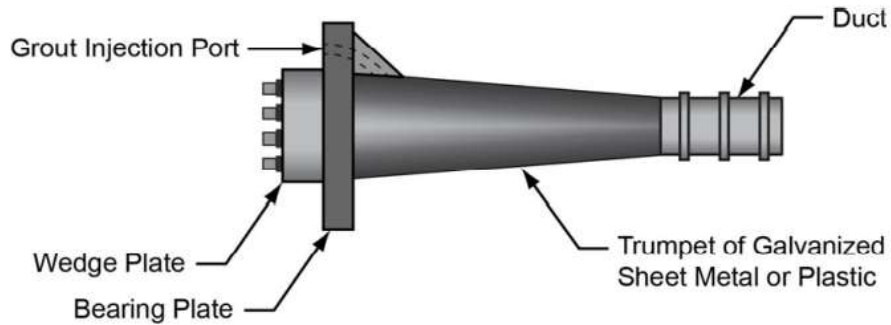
Sistema básico de anclaje de placa de apoyo
